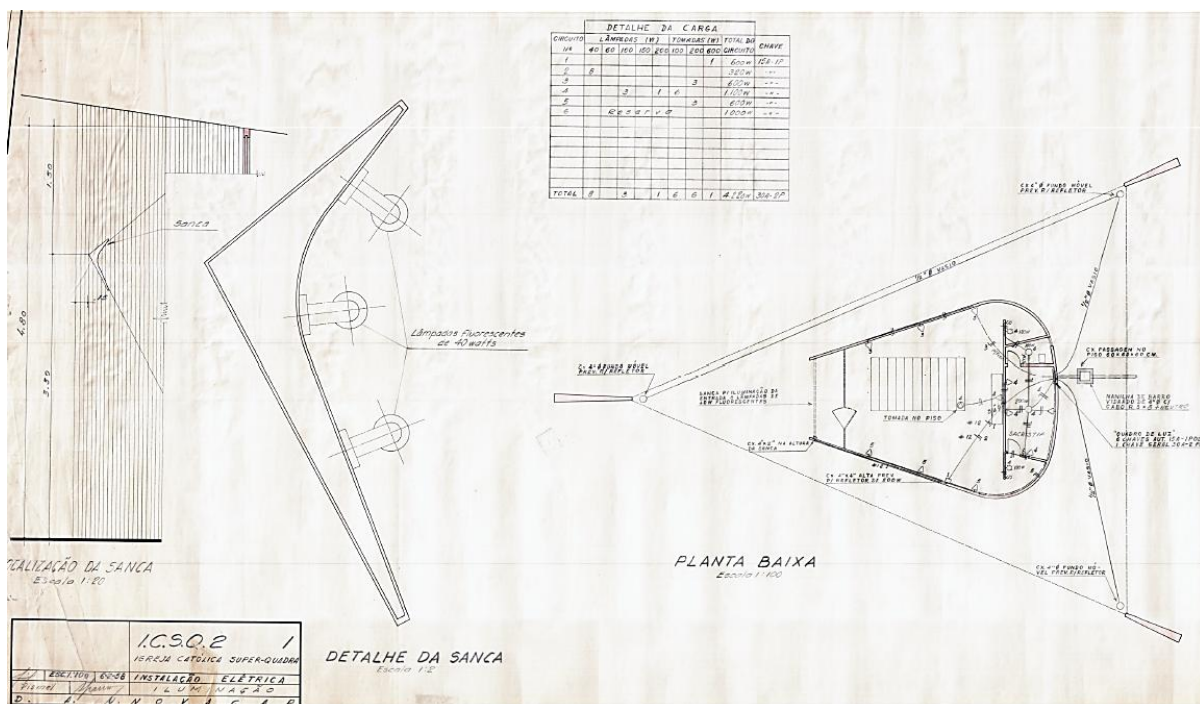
| Projeto construído. Planta de elétrica. 6.2.1958
